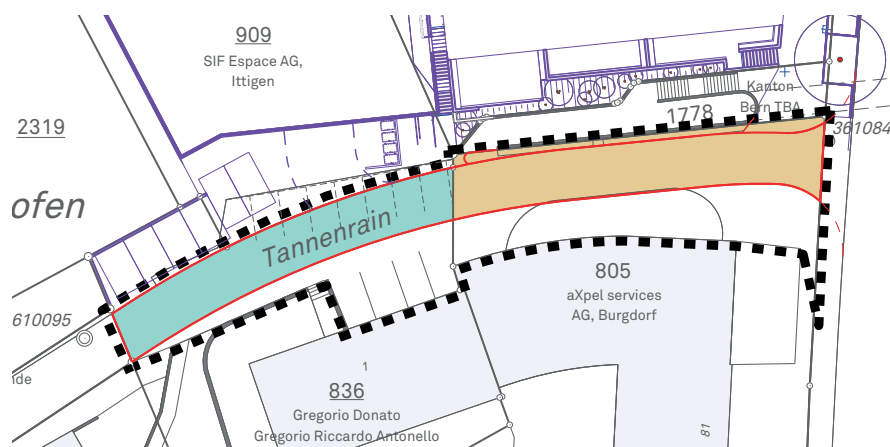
Ausschnitt Landerwerbsplan mit durch dauerhaftem Landerwerb betroffenen Parzellen Nrn. 805 und 836 (nicht massstäblich)
